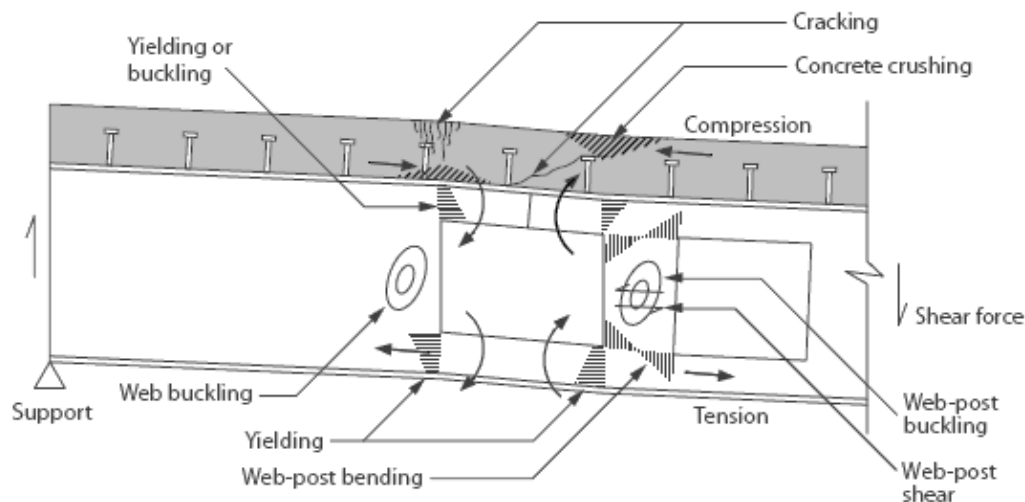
Modos de colapso em vigas alveoladas (Lawson e Hicks 2011)
